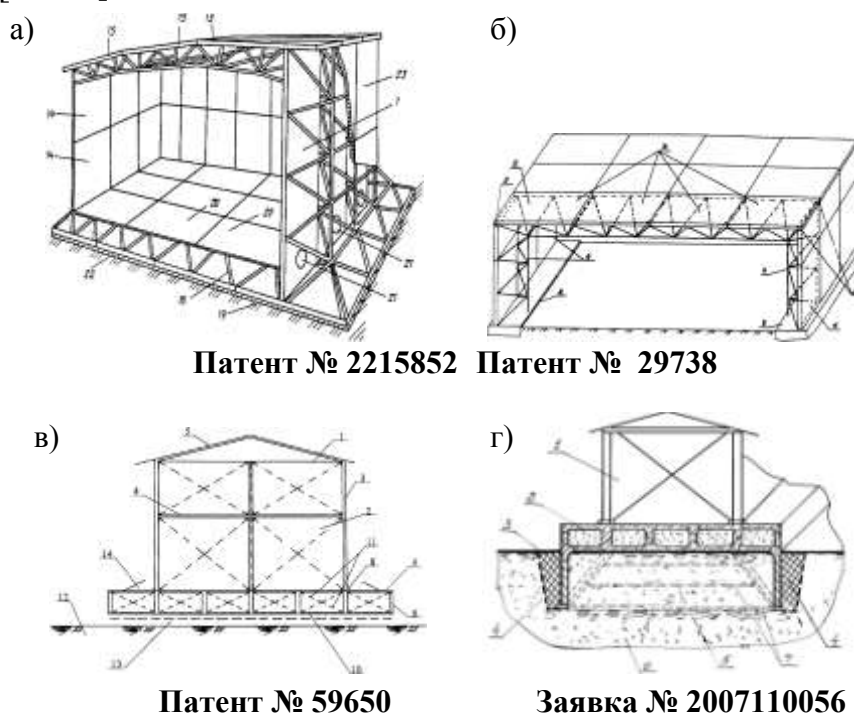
а) полносборное здание и сооружение замкнутого типа (патент № 2215852); б) полносборное здание из сталежелезобетонных элементов (патент № 29738); в) сейсмостойкое малоэтажное здание, сооружение (патент № 59650; г) пространственная фундаментная платформа под здания и сооружения (заявка № 2007110056)
